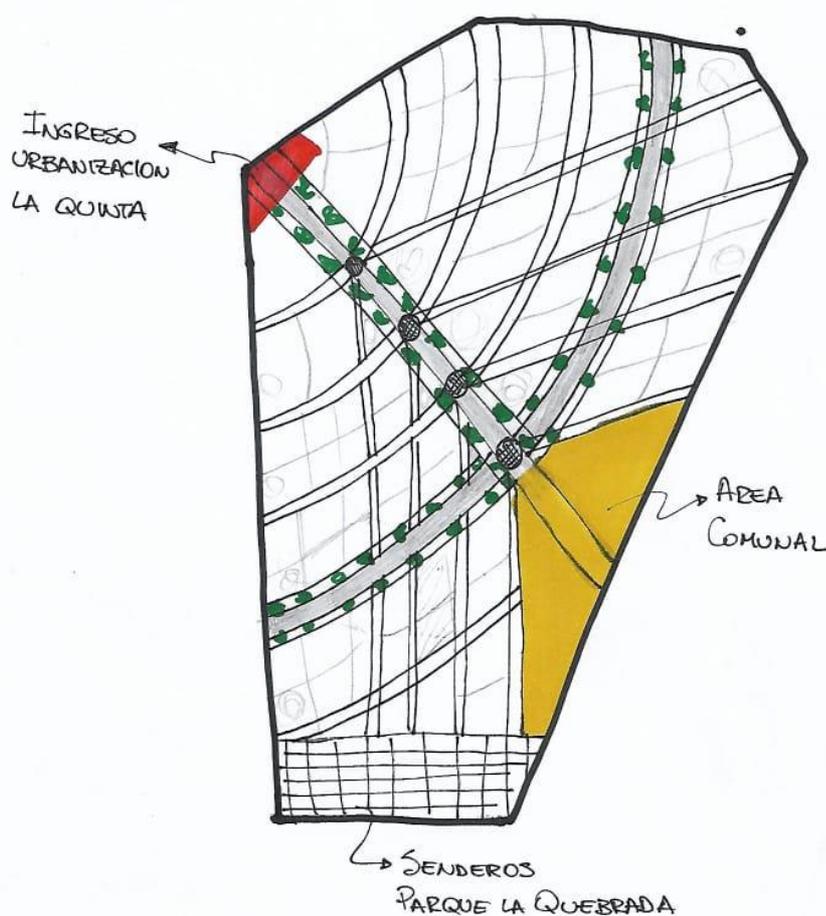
Propuesta de Plan Masa- Elaborado por: Arq. Andrés Herrera
